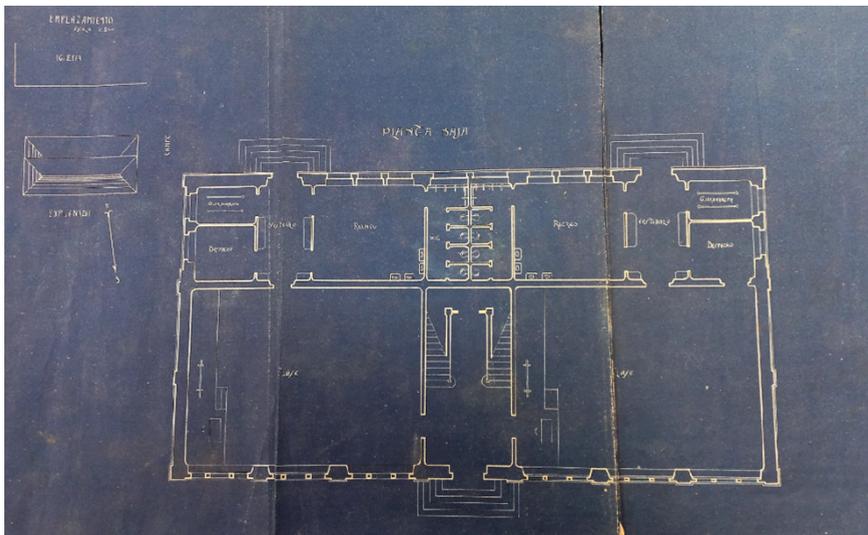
Planta baja. Escuelas de Baños de Río Tobía. Fotografía, ICV.
